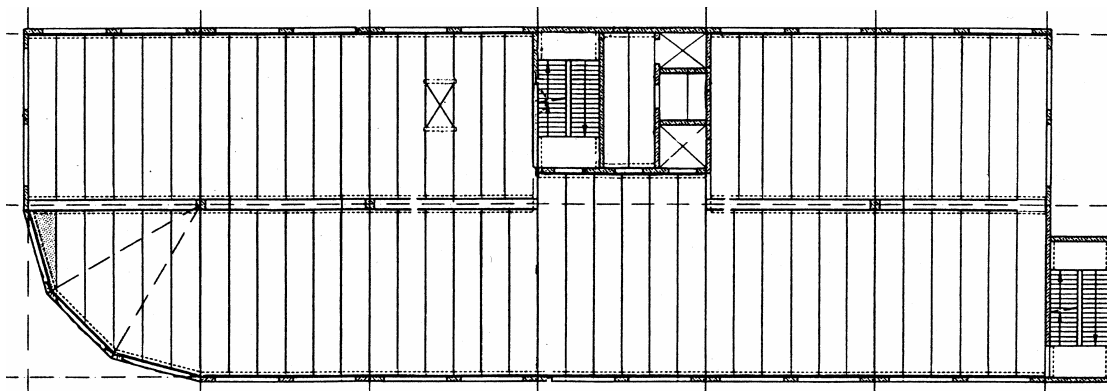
Pavimentos com *layouts* irregulares também são apropriados para a aplicação do concreto pré-moldado
